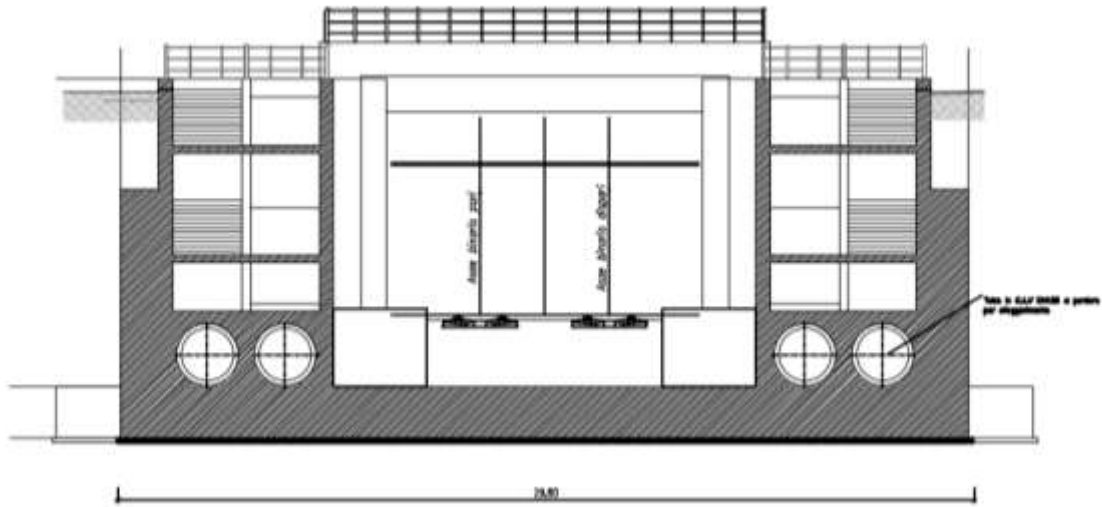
Ambito 10 – Pozzolo SUD Sezione inserimento rampe di accesso alla linea – PK 40+350
